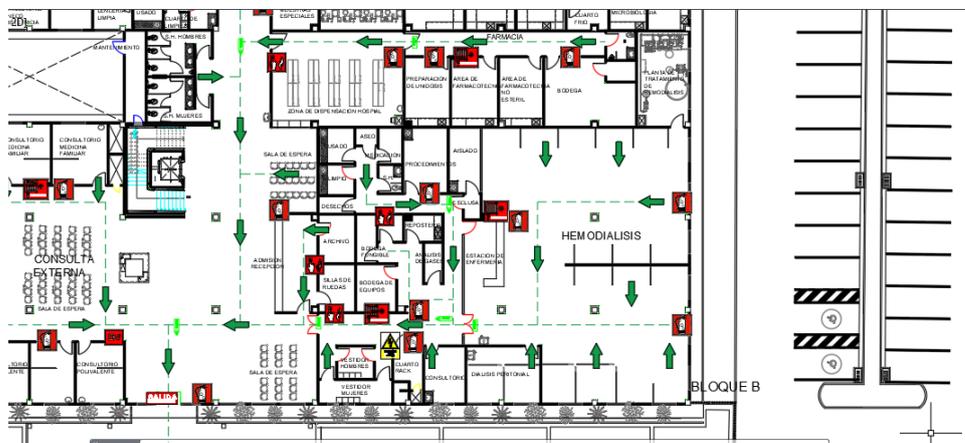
Planos de Evacuación - Planta Baja – Área de Laboratorio
